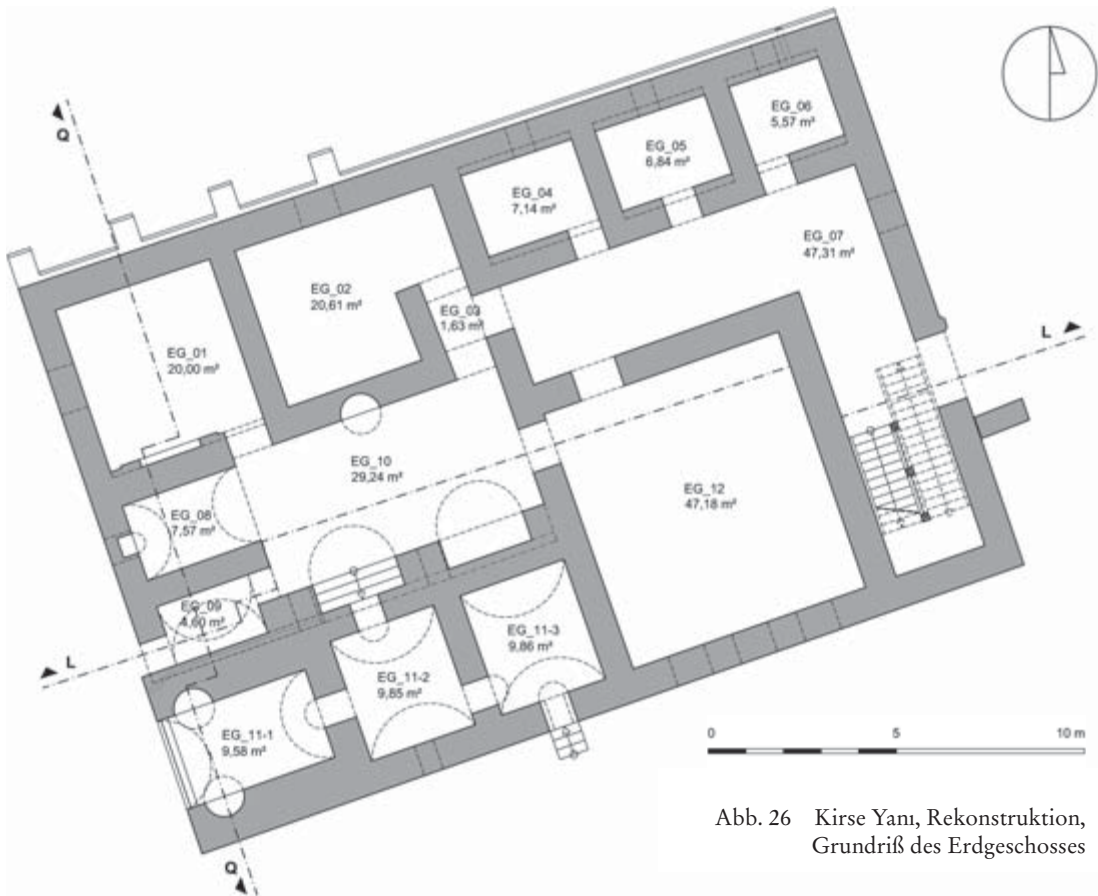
Kirse Yanı, Rekonstruktion, Grundriß des Erdgeschosses
